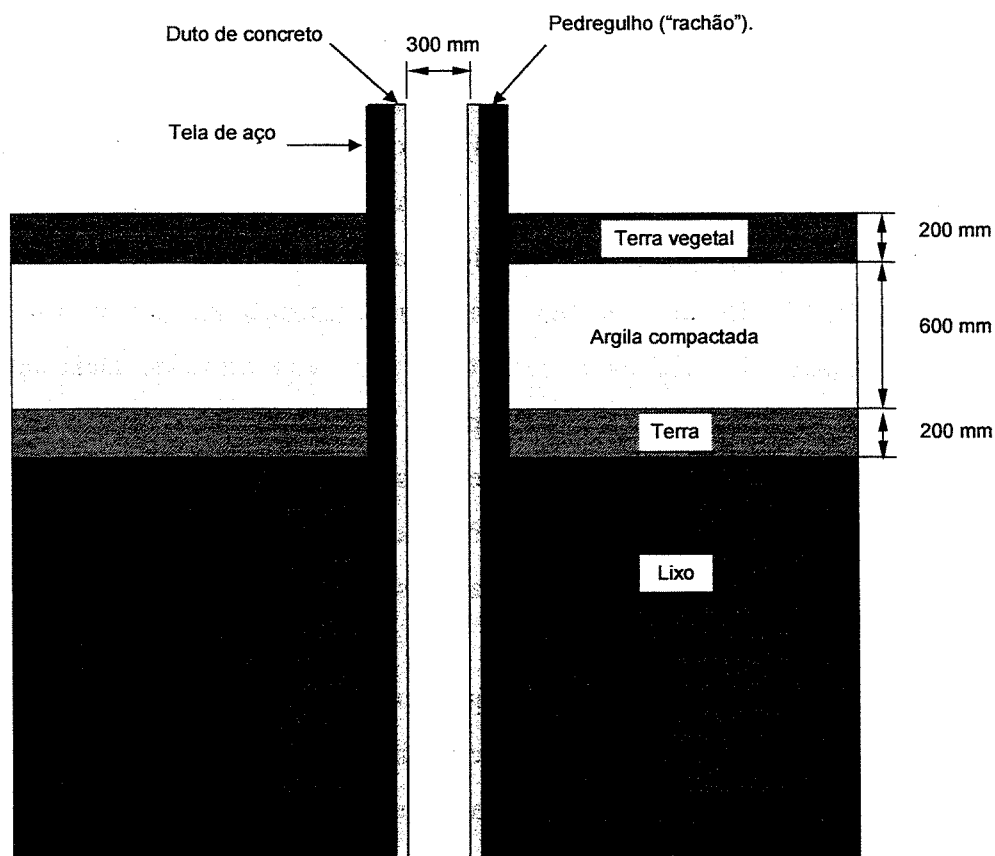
Camadas de cobertura do aterro e dreno de biogás
